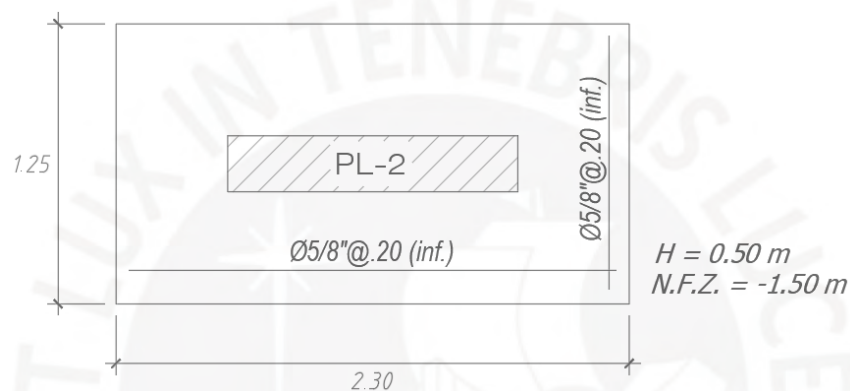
Diseño final de la zapata aislada de la placa PL-2
